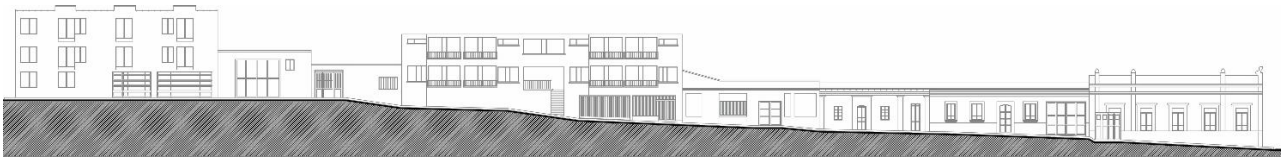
Levantamiento de Fachadas carrera 13 entre calle 16 y 17
